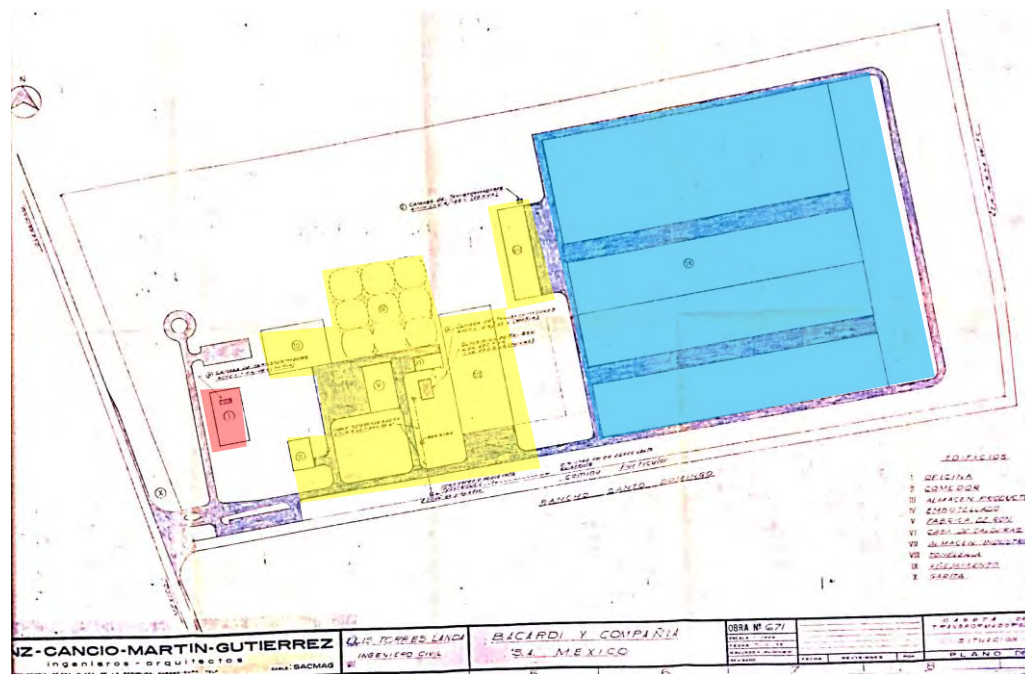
Plano con propuesta mas avanzada (intervenido)
